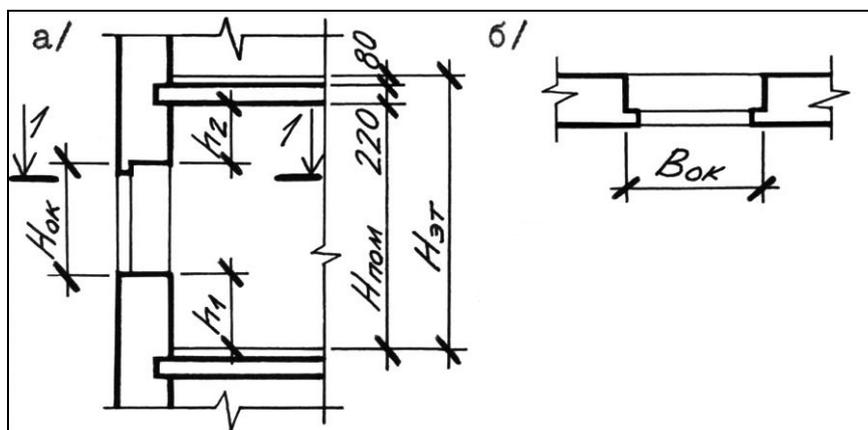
Фрагмент разреза здания (а) и фрагмент плана здания (б)
